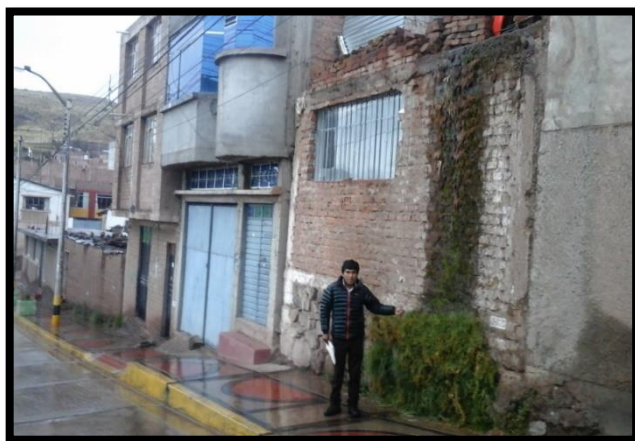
Vivienda con filtración en el muro insuficiente altura del sobrecimiento, mala composición del concreto y fuentes de humedad junto al muro exterior.
